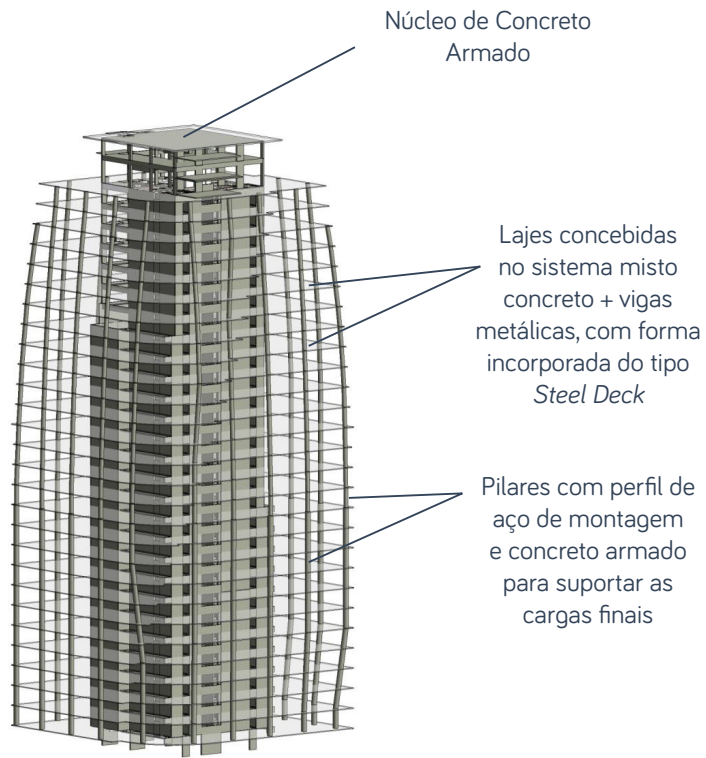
São Paulo Corporate Towers | Solução Estrutural
